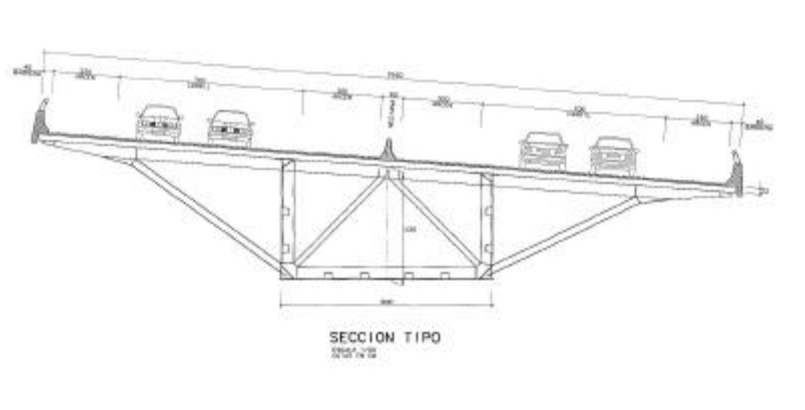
Sección transversal tipo. Viaducto sobre el río Navia
